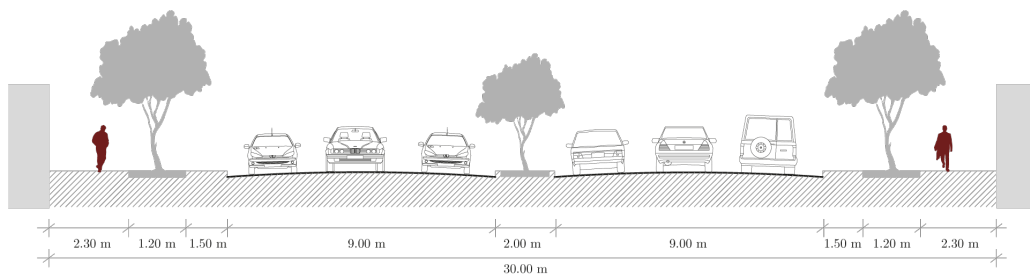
Sección de la calle Eastern Pkwy. Elaboración: Propia
